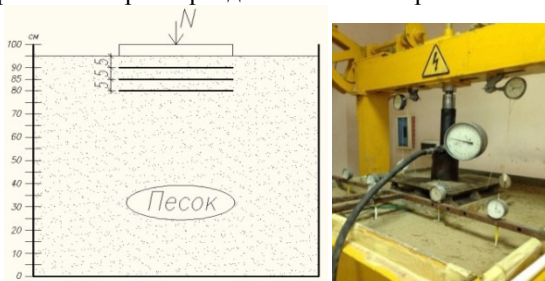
Схема испытания грунтового основания с тремя армирующими элементами при статическом нагружении
